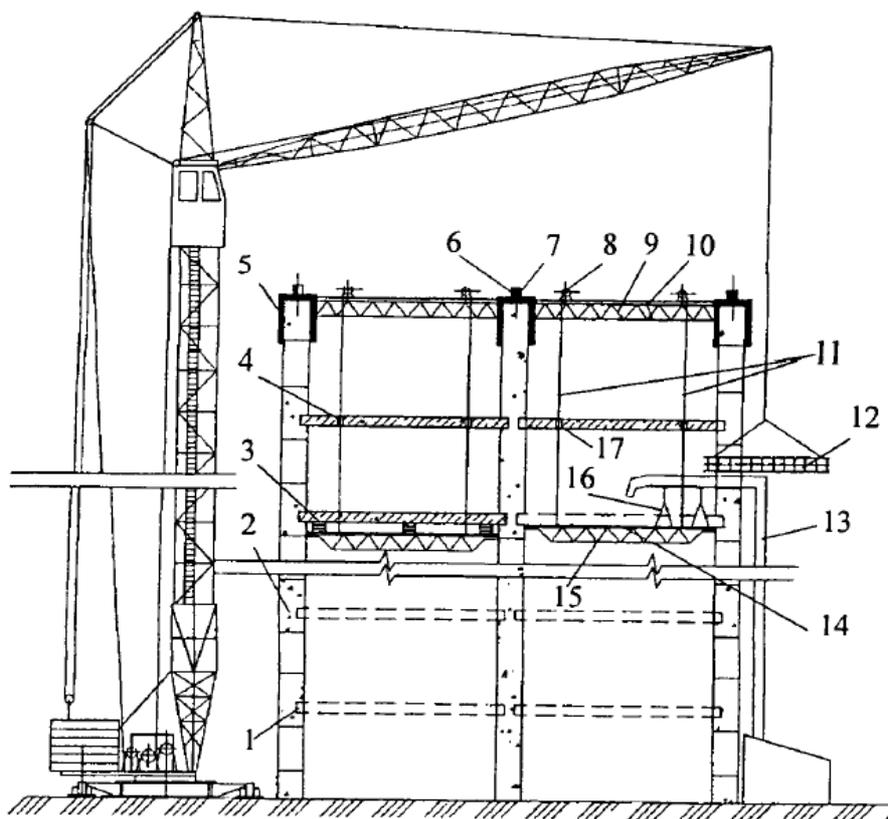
Бетонирование междуэтажных перекрытий методом «сверху вниз»:
